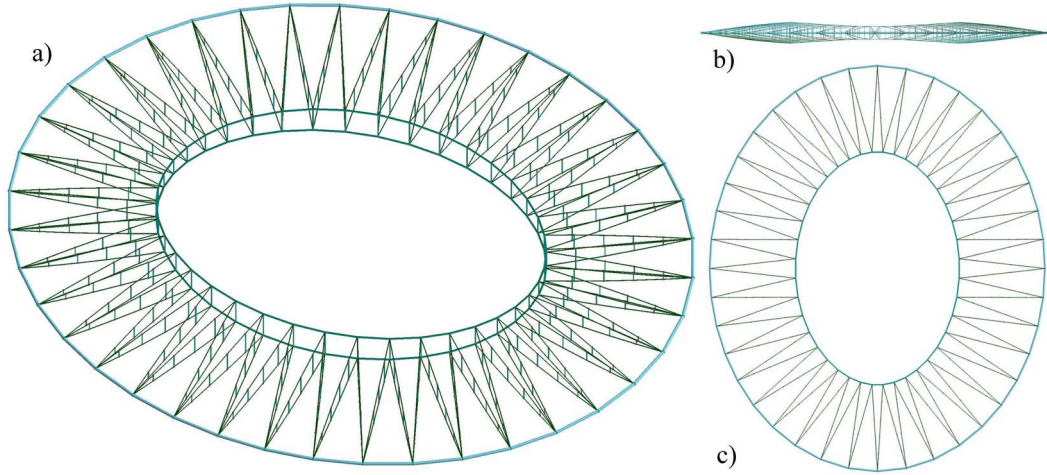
Diseño tridimensional la RTRT sobre el graderío del Coliseo: a) Axonometría, b) perfil y c) planta.
